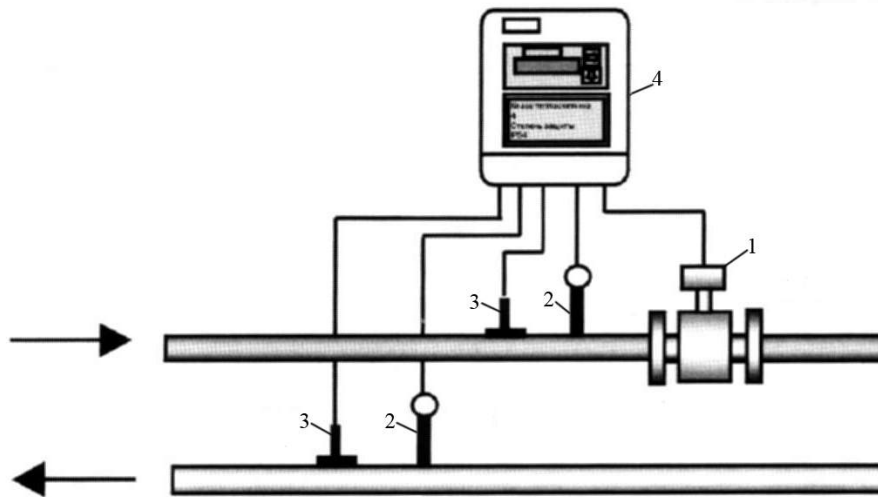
Схема установки теплосчетчика на подающем трубопроводе:
